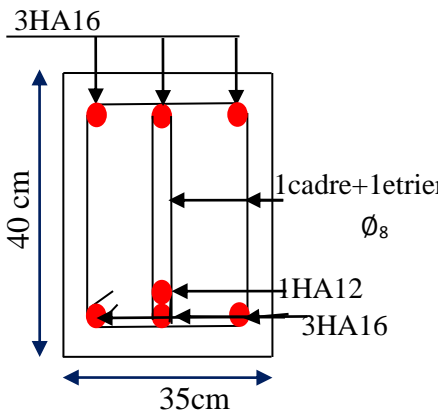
Exemple de dispositions constructives de la poutre principale.
